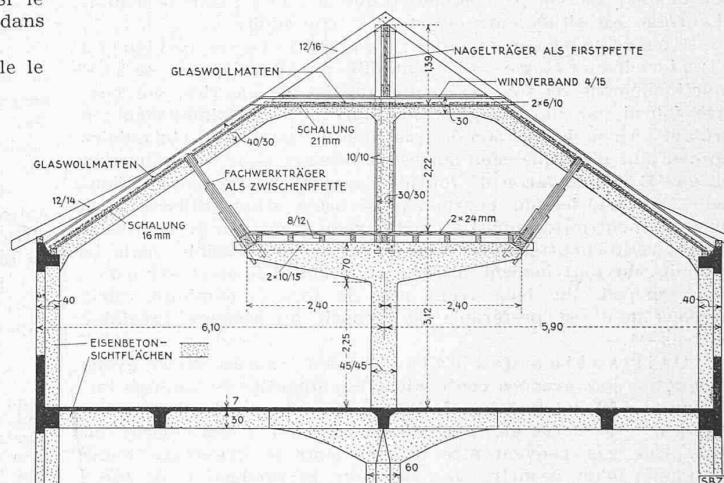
Schnitt des Dachstocks und Dachstuhls. — Masstab 1:120
